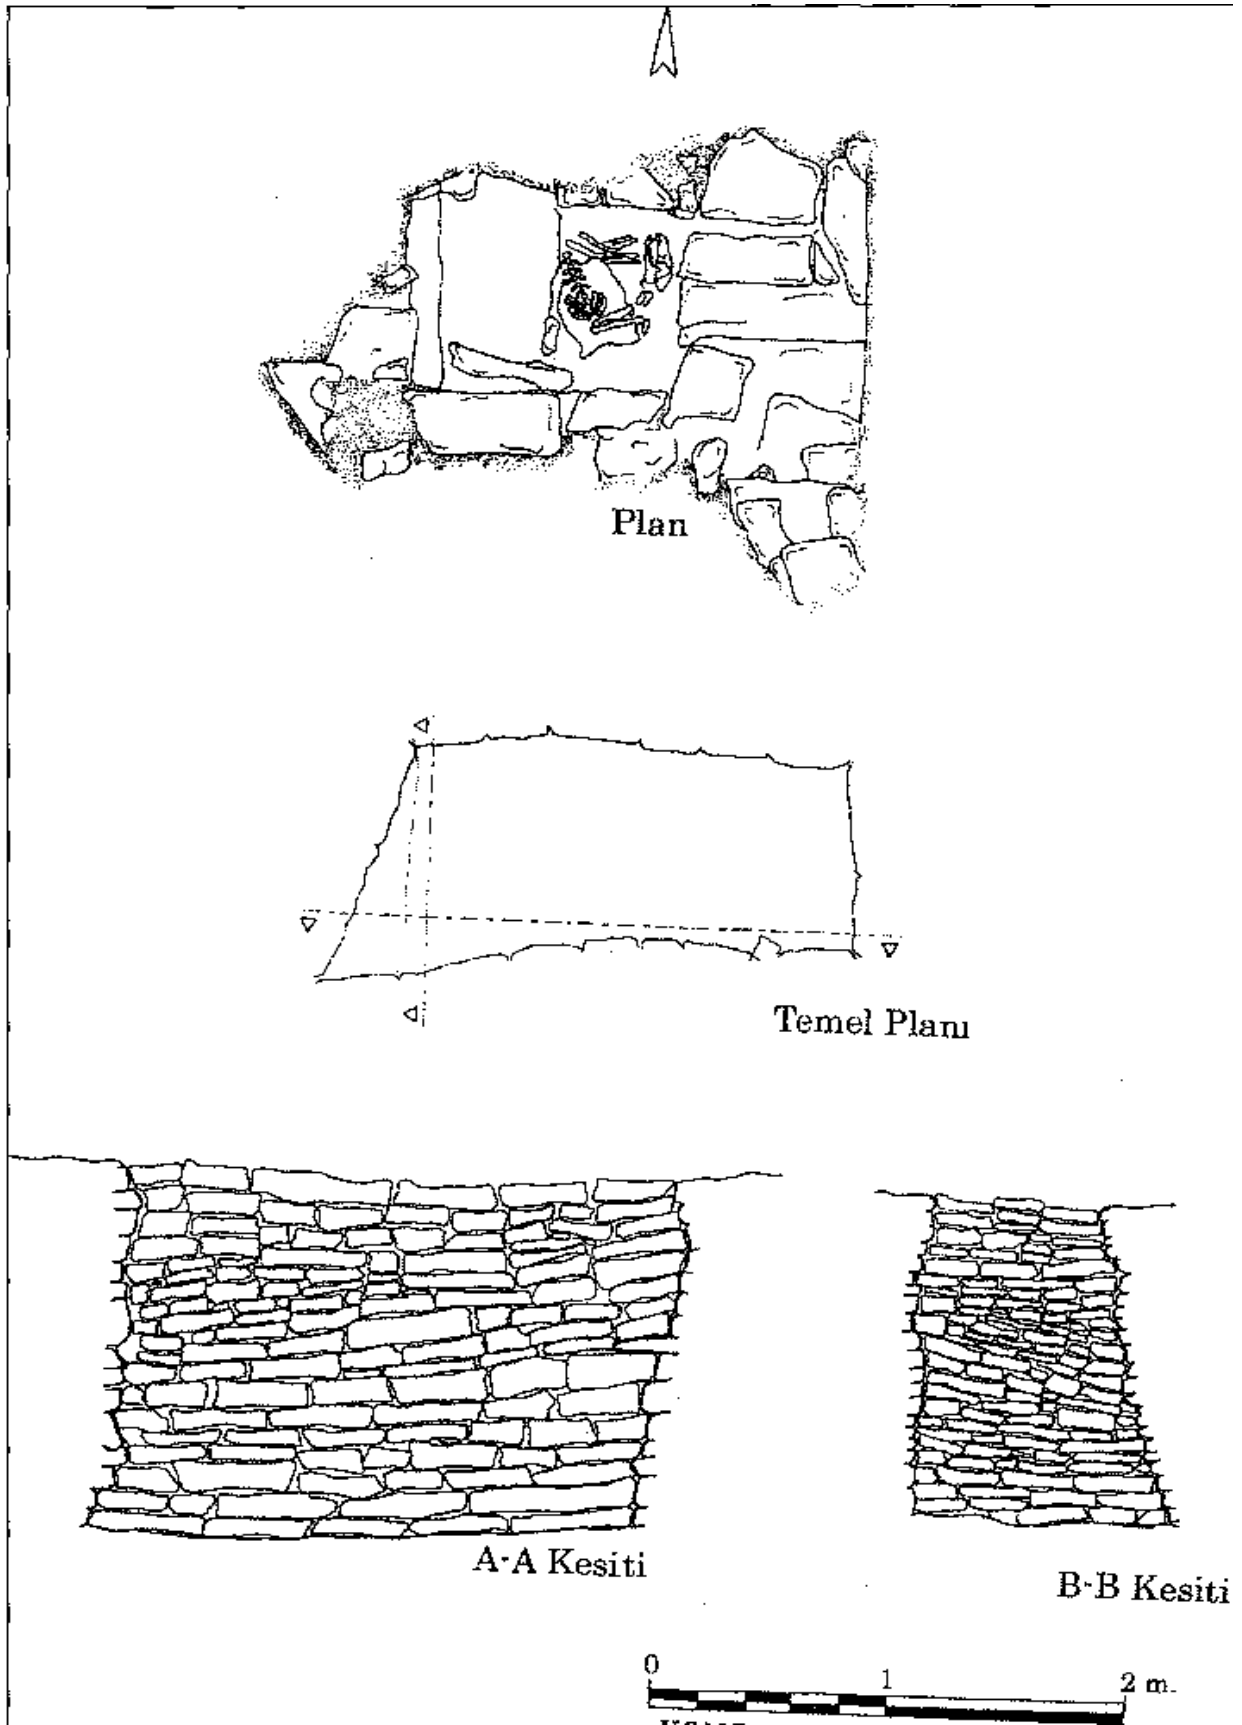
Mezar 4 plan ve kesiti [35].
